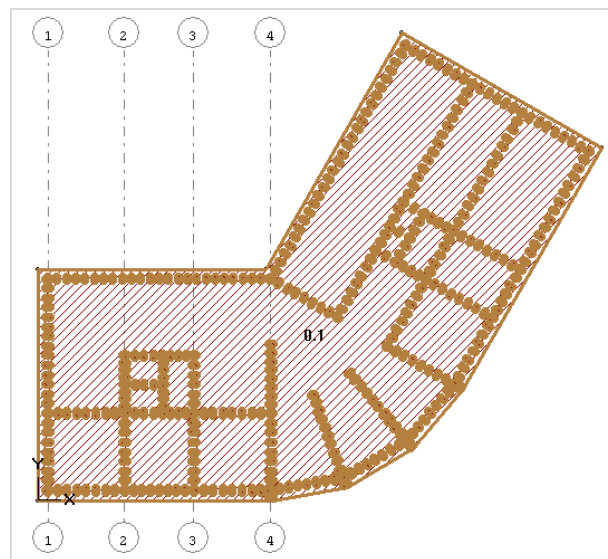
Фундаментная плита №1\_1 с нагрузками
